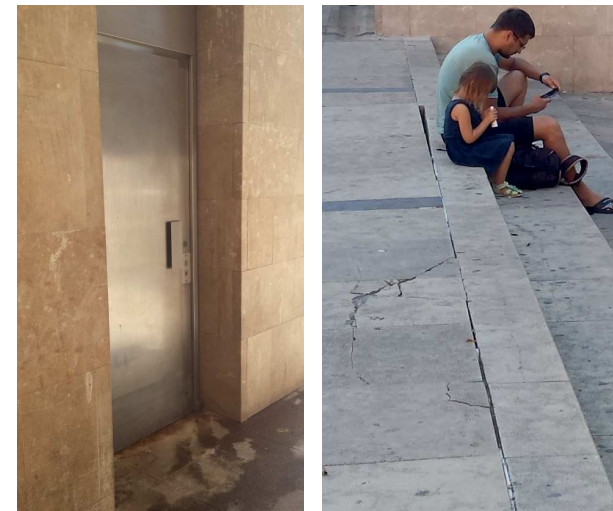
Orines en zona ascensor y agrietamiento pavimento de la plaza debido al deslizamiento de las escaleras.
